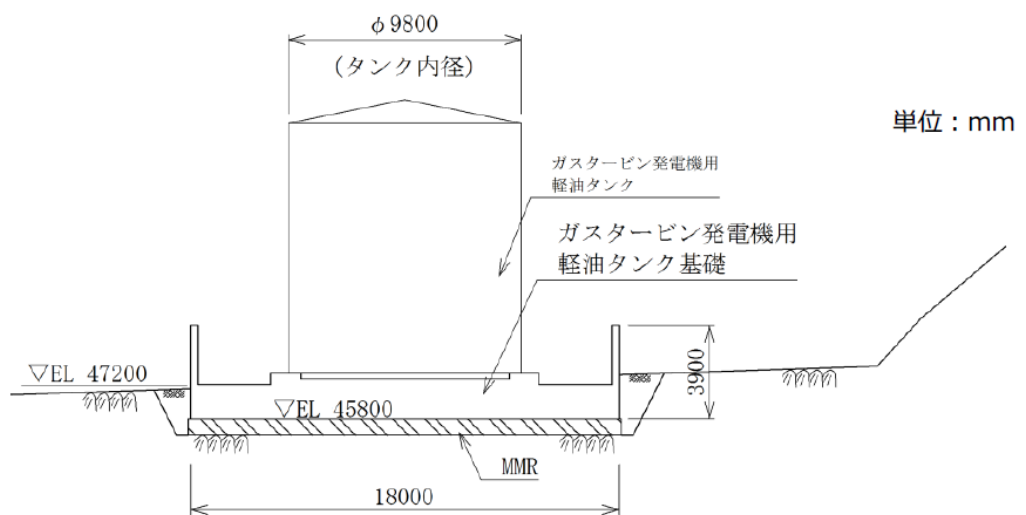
ガスタービン発電機用軽油タンク基礎 断面図 (A-A断面)
